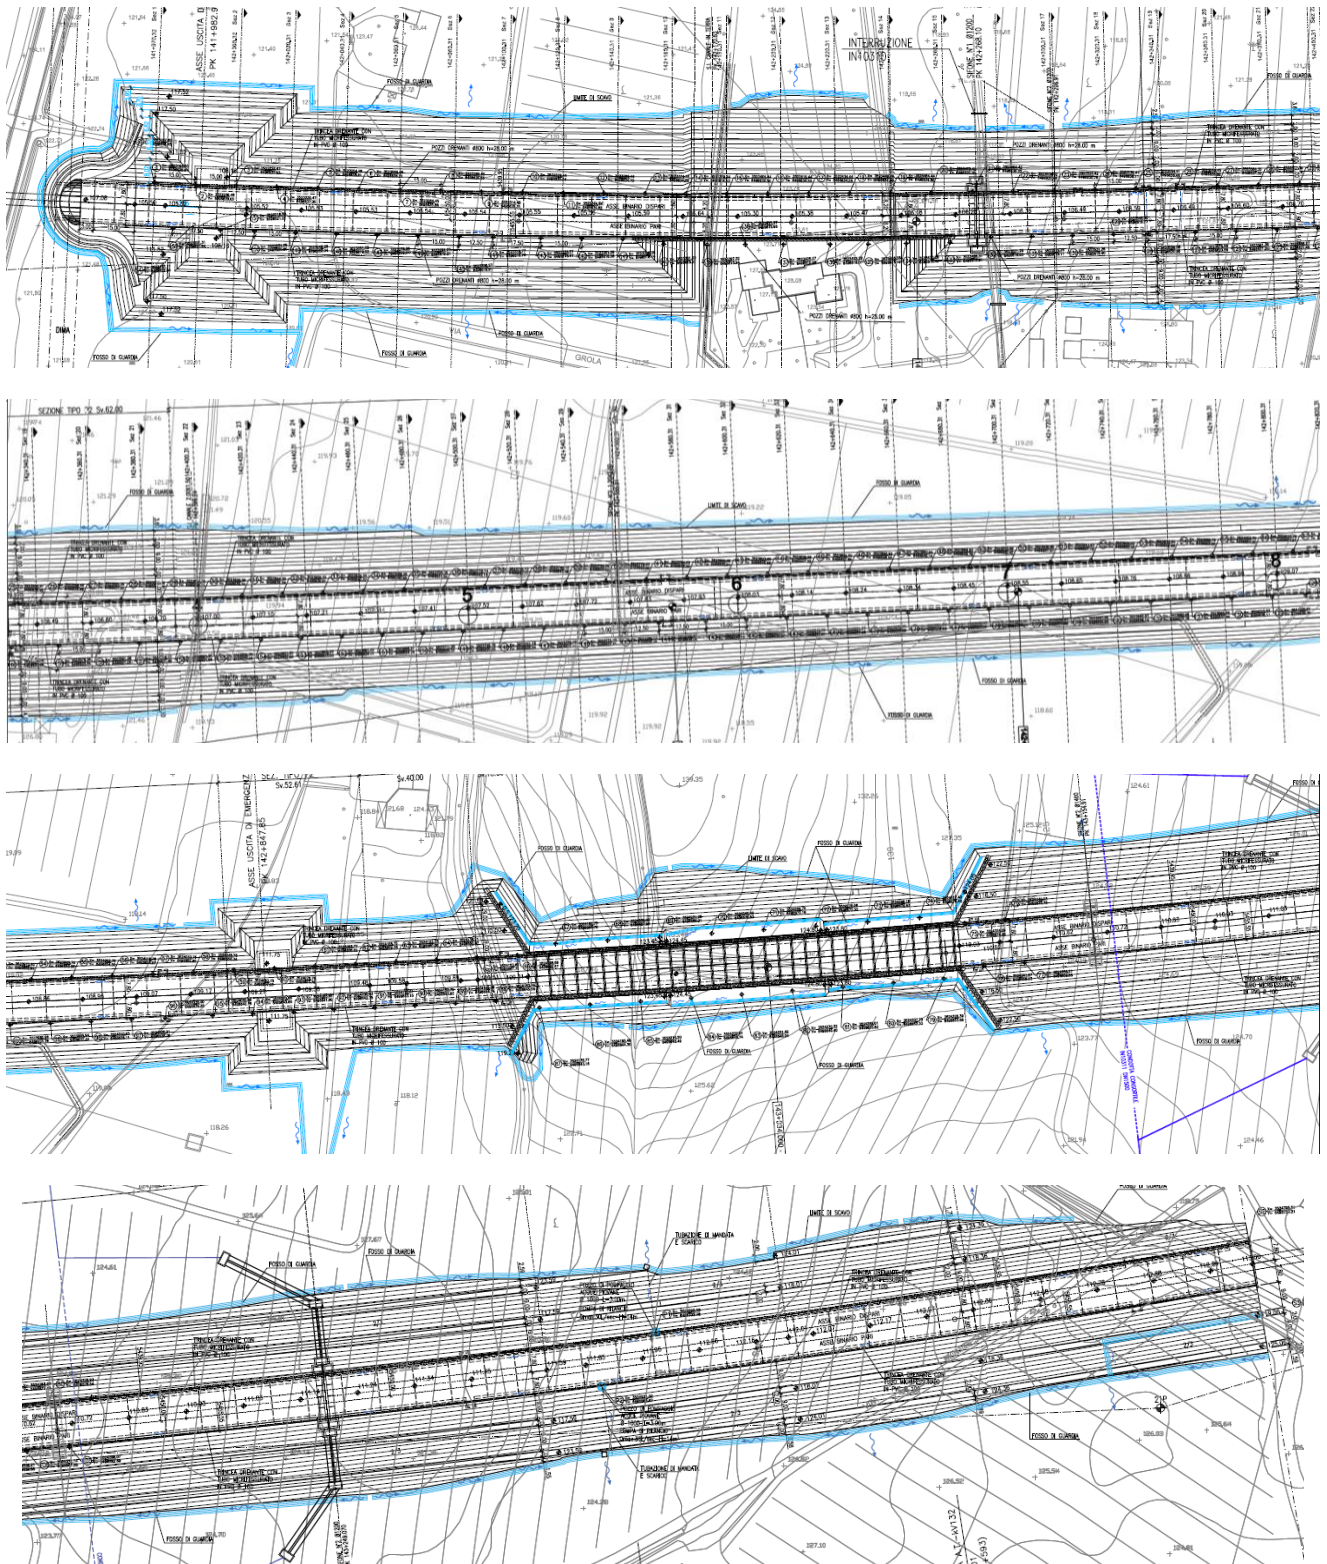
Planimetria di scavo galleria artificiale San Giorgio est.
